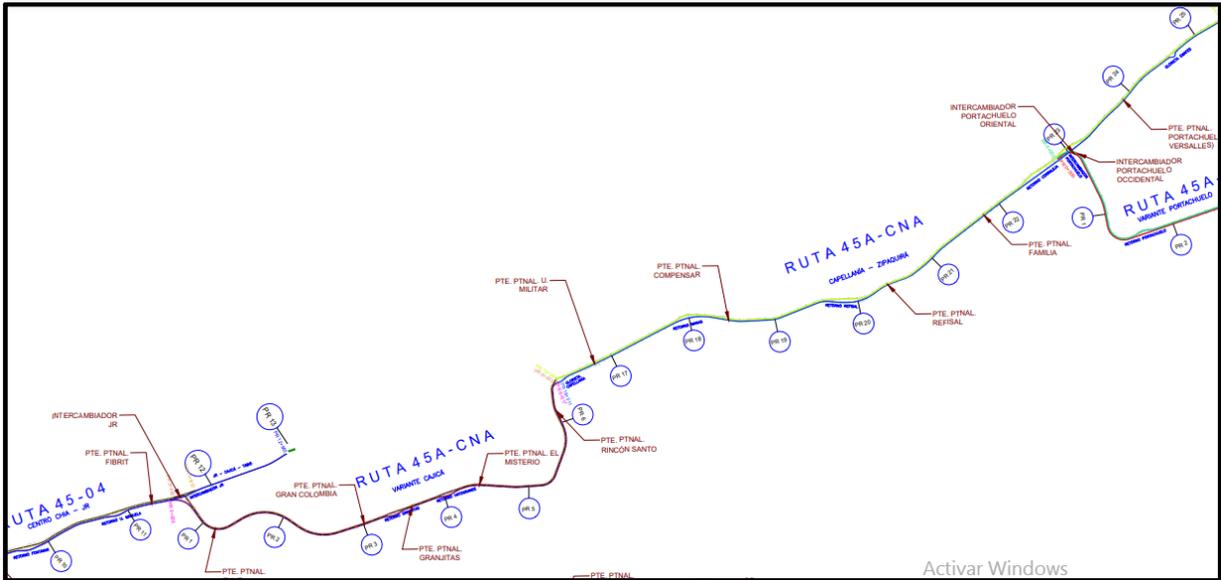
Ubicación de las estructuras de inspección Ruta 45.
